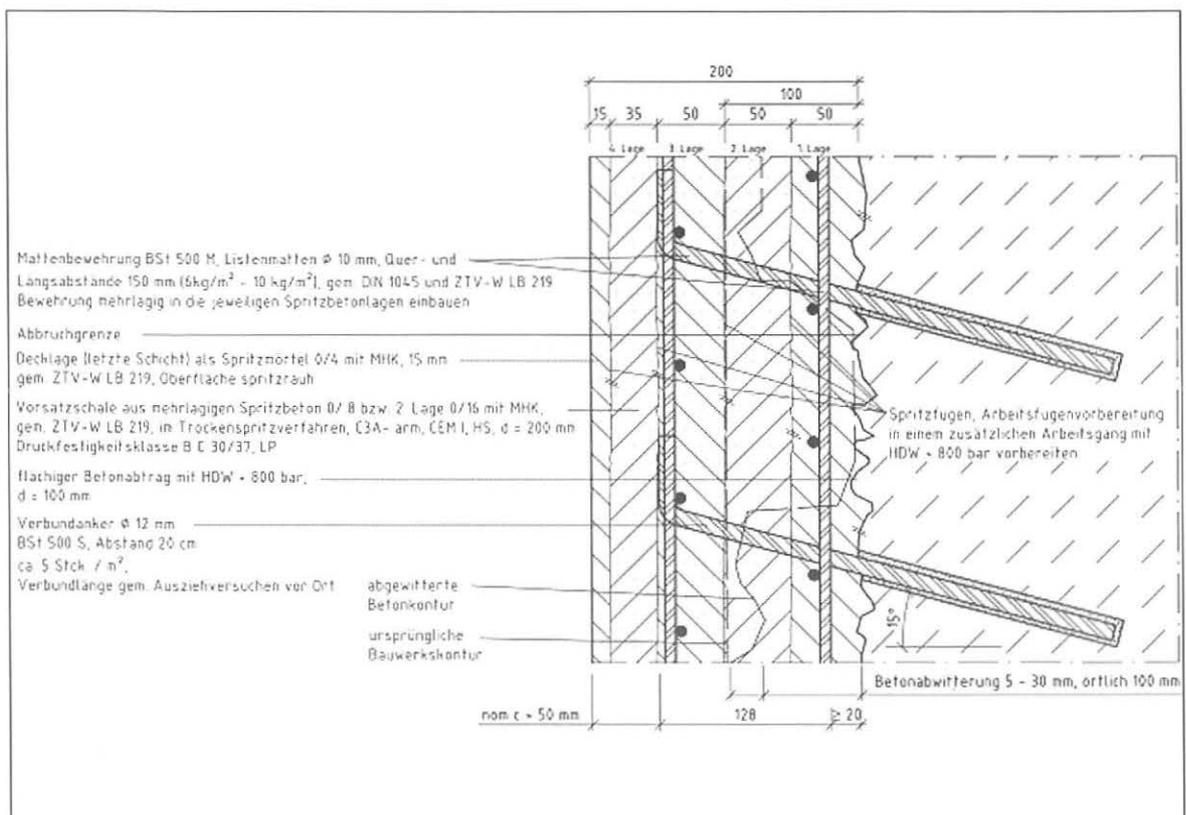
Vorsatzschalung aus Spritzbeton für Schleusenammerwände und vergleichbare Bauteile
